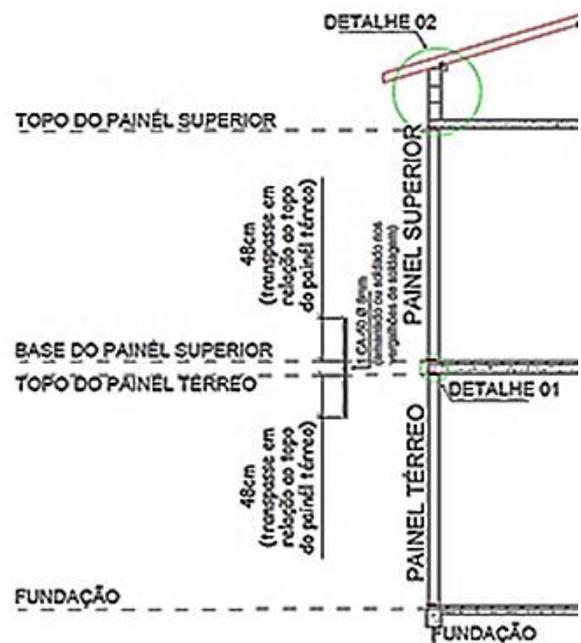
Ligações entre dois painéis e barra de transpasse entre painel do pav. térreo e painel do pav. superior.
